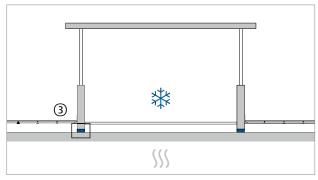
Structure en toiture avec un système Schöck Sconnex®
